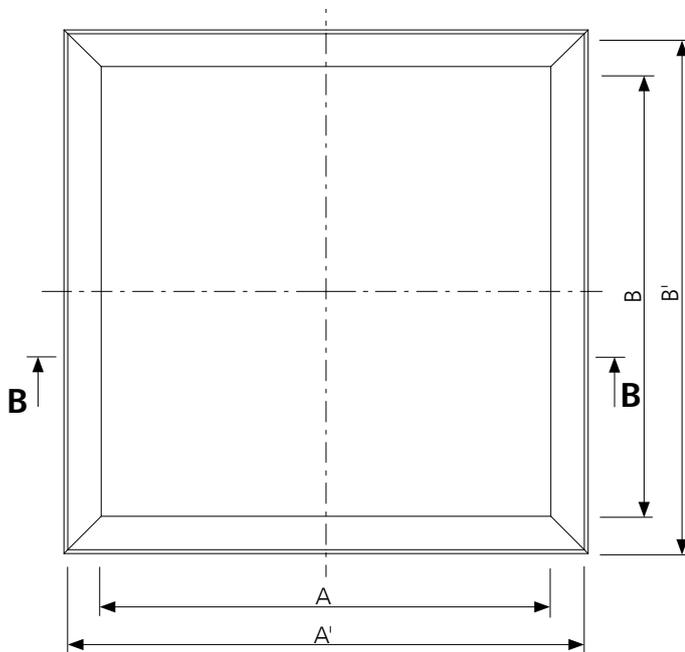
Draufsicht von einem Dachausstieg mcr ULTRA THERM Typ C in geschlossener Position
